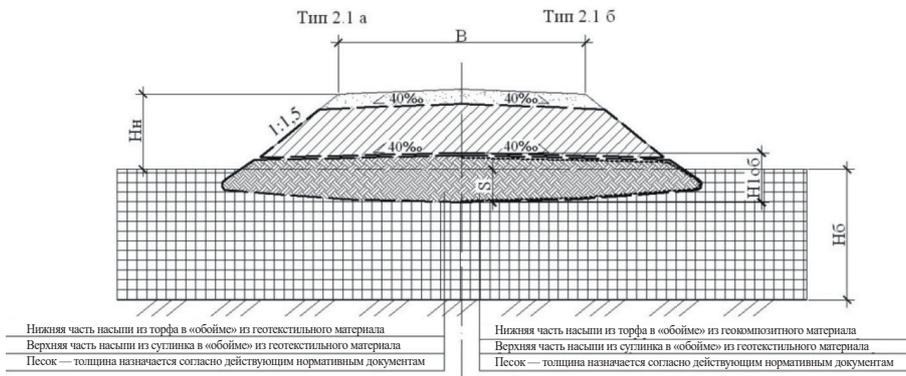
Конструкция земляного полотна на болотах 1-го и 2-го типов
